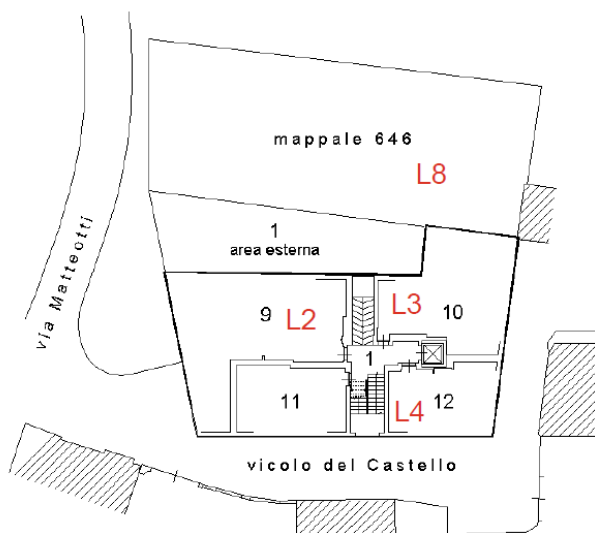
ESTRATTO ELAB. PLANIMETRICO C.F.
